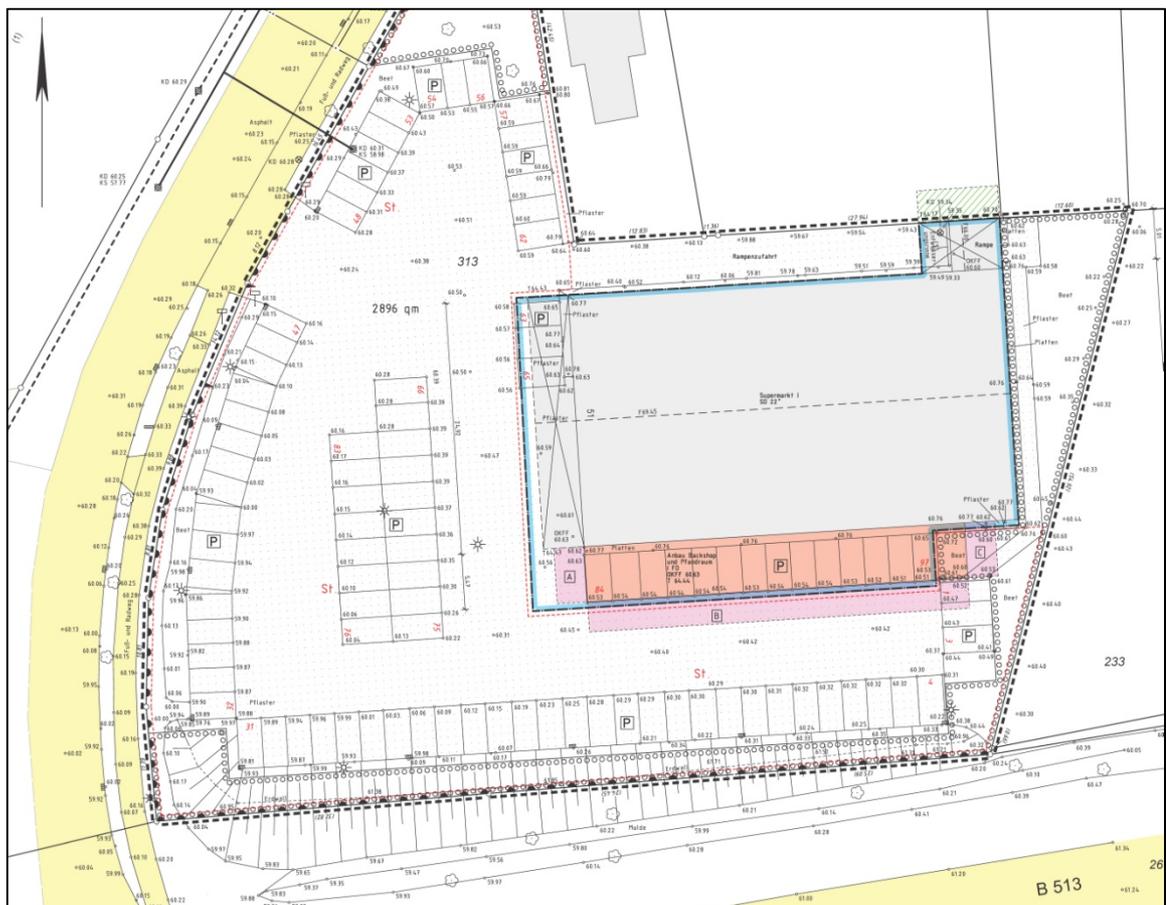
Amtlicher Lageplan zum Bauvorhaben (Ausschnitt) /12/
